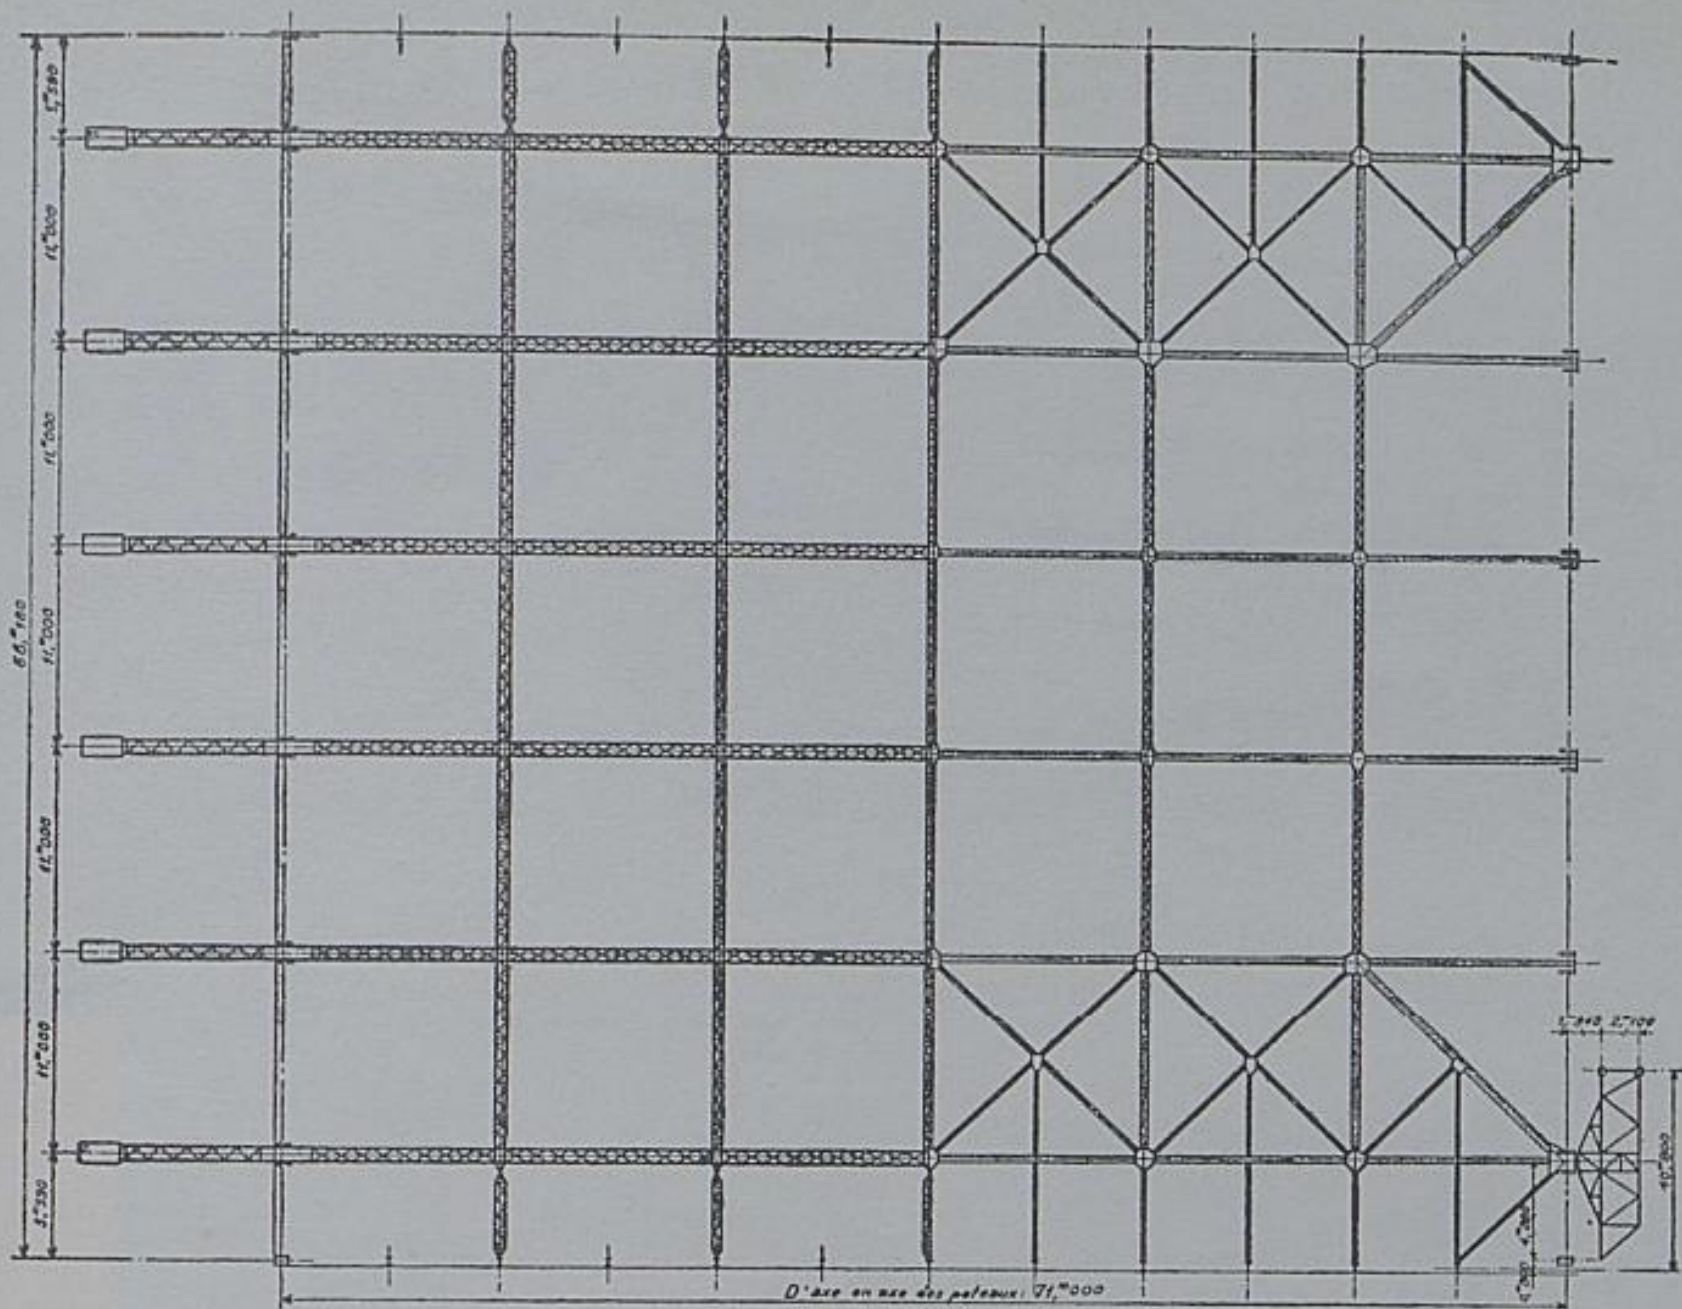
Vues en plan des butons et de la poutre au vent.
